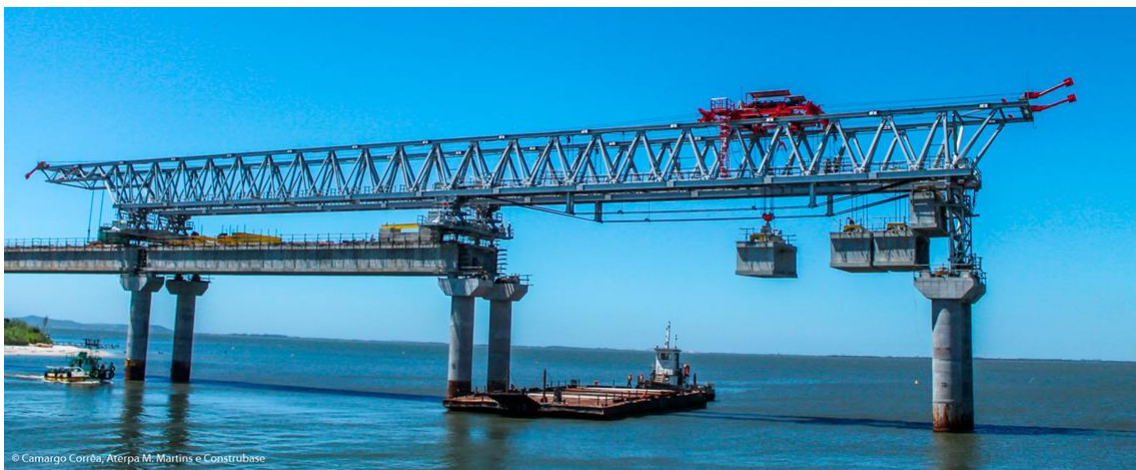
Pórticos de lanzamiento para la colocación y tesado de piezas prefabricadas (Fuente: BERD construcción).
